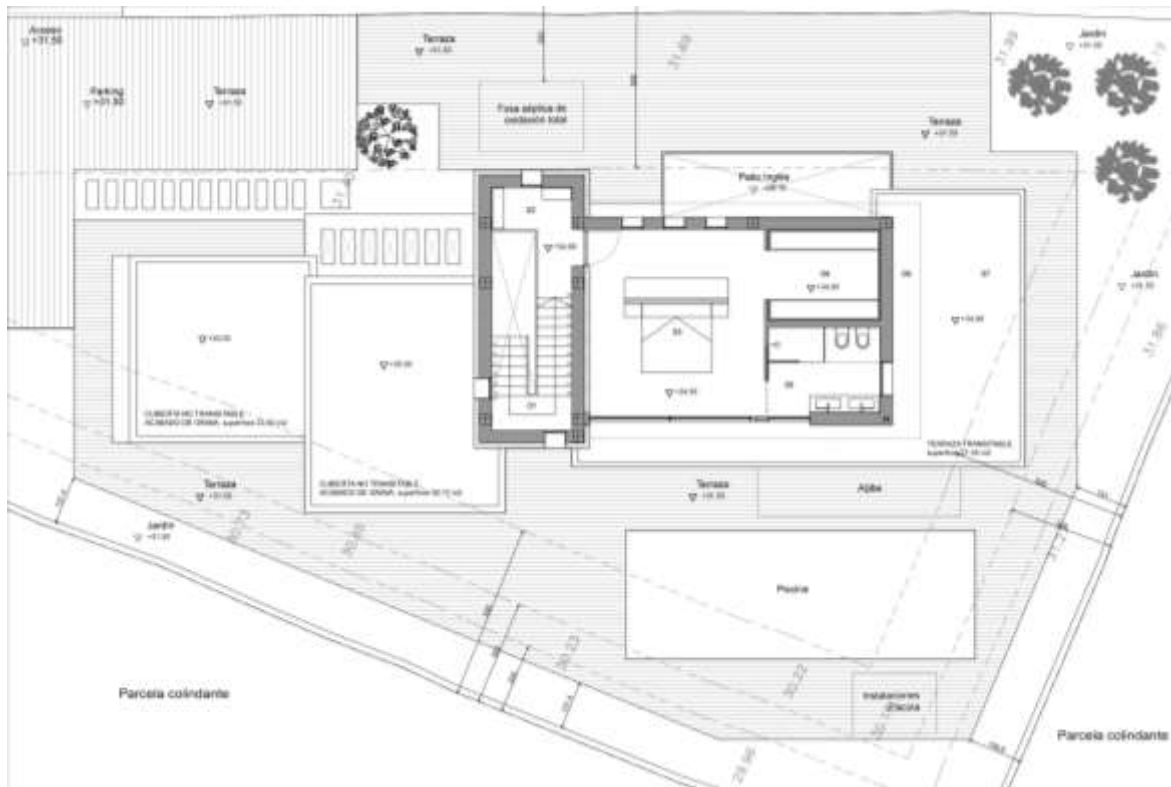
Planta primera. Fuente: proyecto básico y de ejecución.
